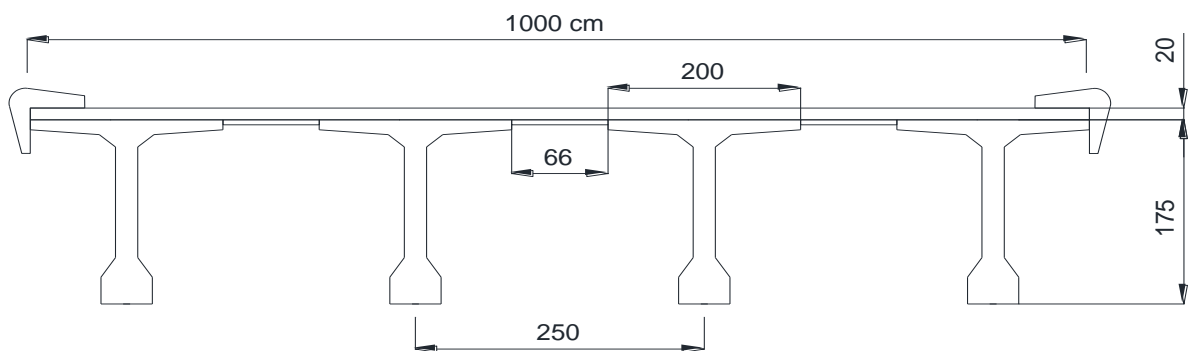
Coupe transversale du tablier de pont à poutres en BP
